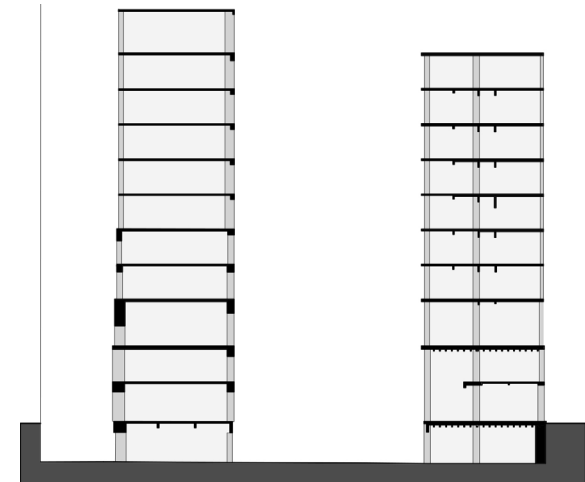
Sección AA' mantenido. (Autoría propia, 2021).
